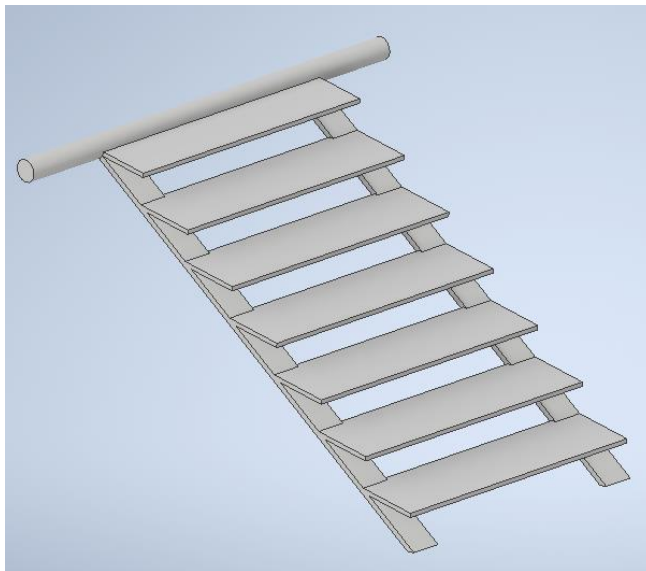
Escalera con dos vigas colocadas en ambos extremos de los peldaños
